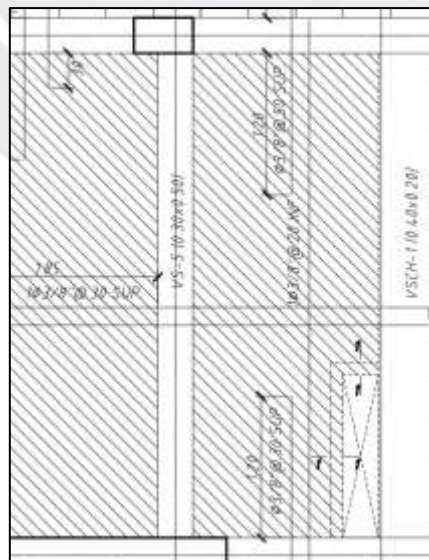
Disposición de acero de refuerzo en la losa maciza 2
